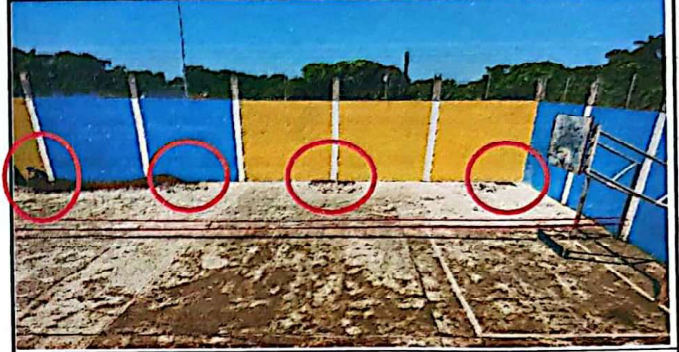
MANTENIMIENTO DE CANCHA CON 4 COLUMNAS METALICAS TIPO JOIST
